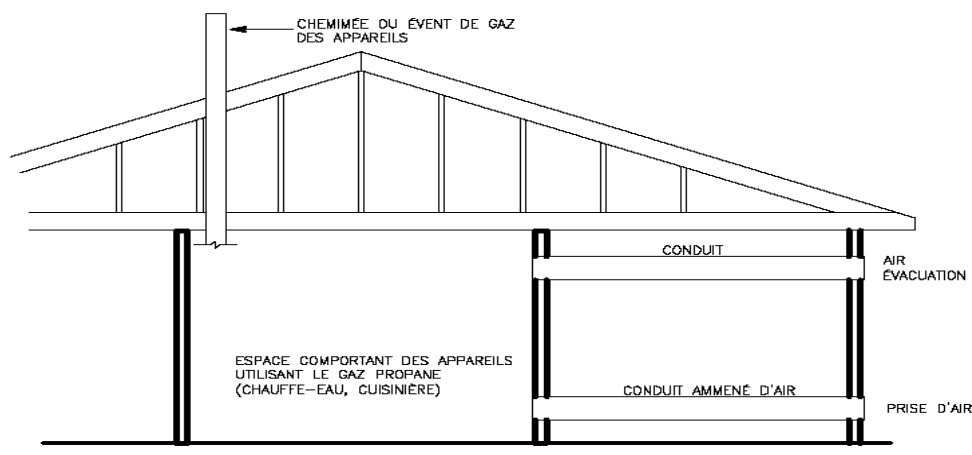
b - Exemple d'ouvertures directes par conduits sur l'extérieur
